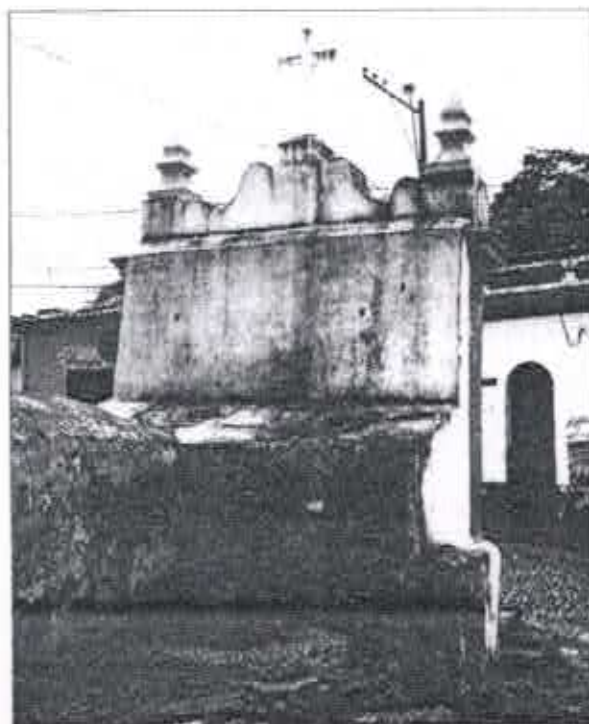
Vista da fachada posterior do Chafariz antes da restauração.
